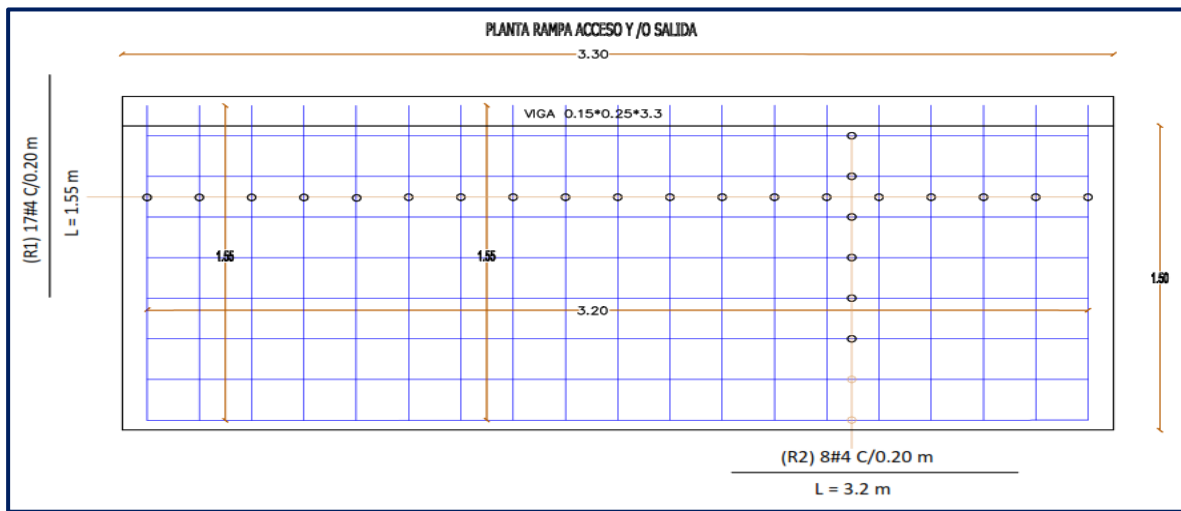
Vista de planta Rampa acceso / Salida diseño placa huella de 4.5 m
